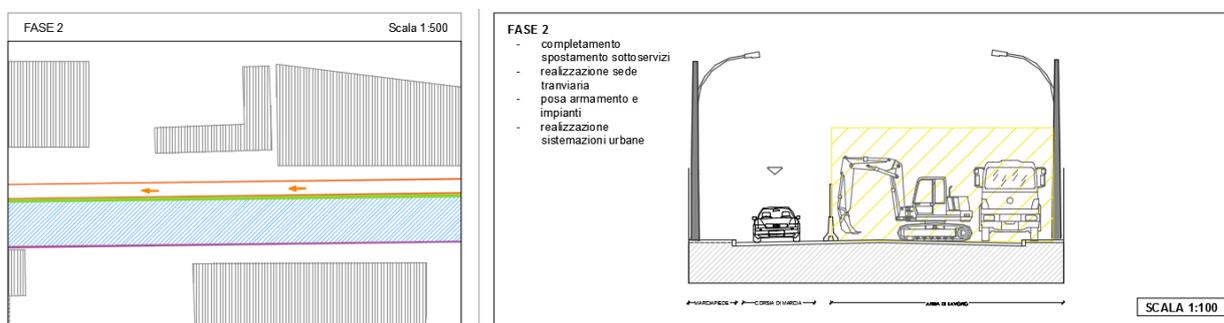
Tipologico cantiere con sede laterale Fase 2
